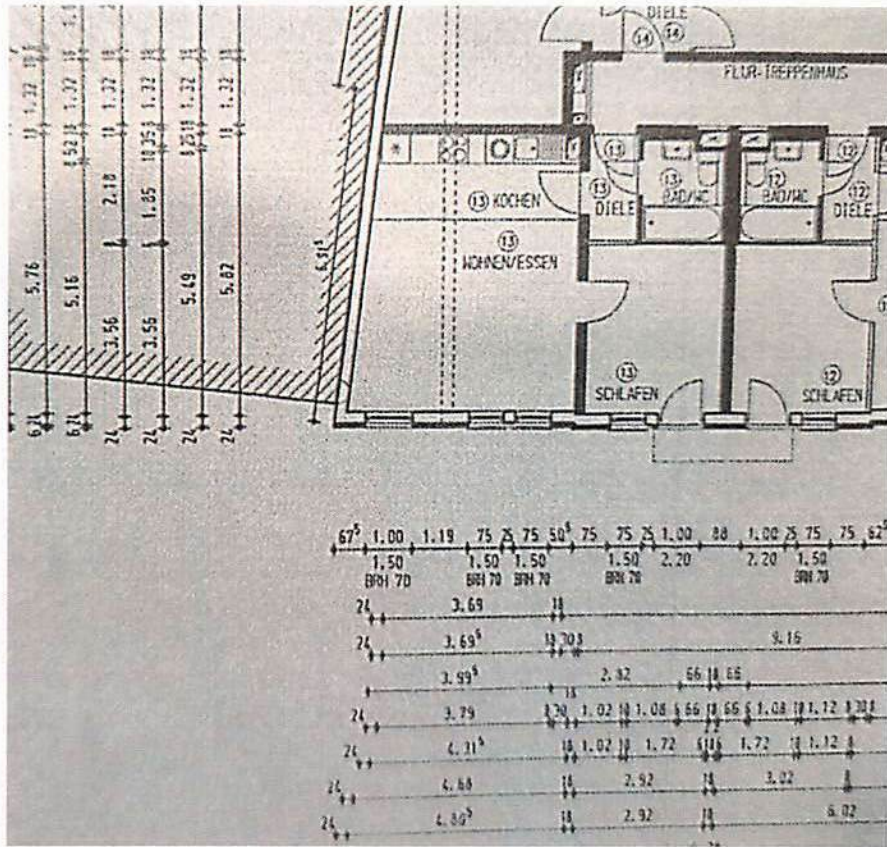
Ausschnitt Grundriss 1.OG mit ETW Nr. 13
